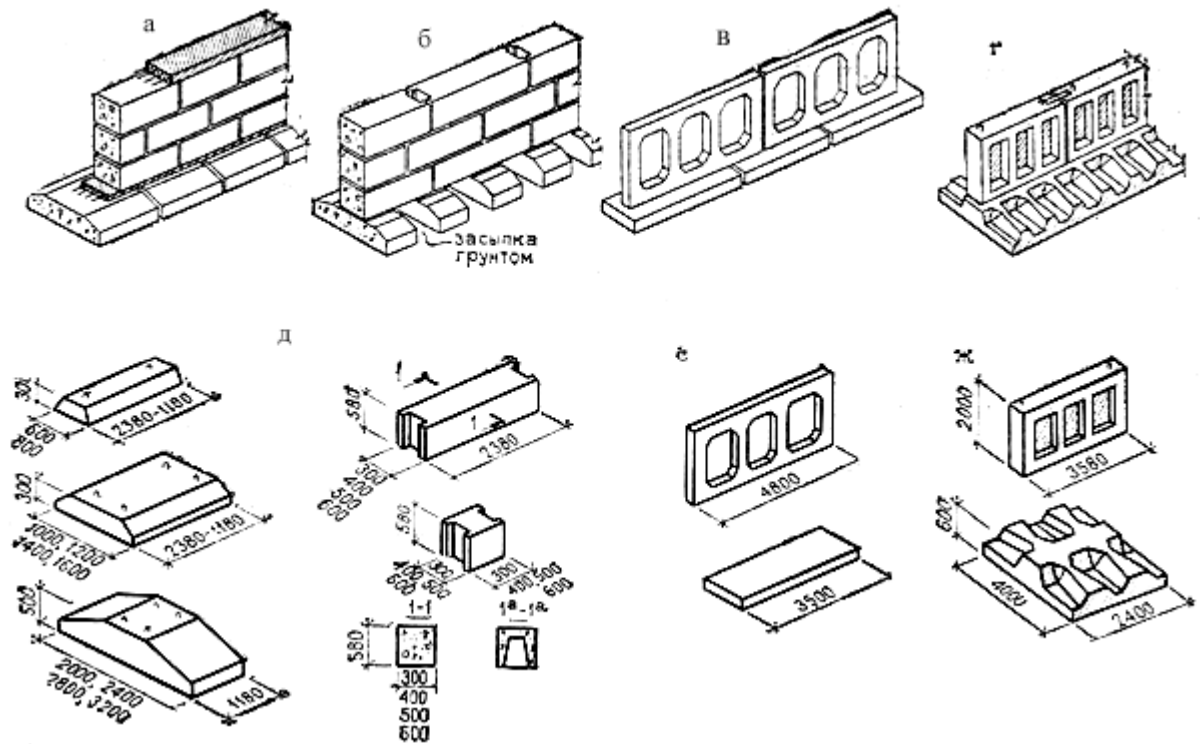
Збірні стрічкові фундаменти: а - конструкція фундаменту при слабких ґрунтах; б - укладання фундаментних блоків при щільних ґрунтах і малих навантаженнях; в, г - фундаменти великопанельних будинків; д - елементи збірних великоблочних бетонних фундаментів; е, ж - елементи великопанельних фундаментів.
